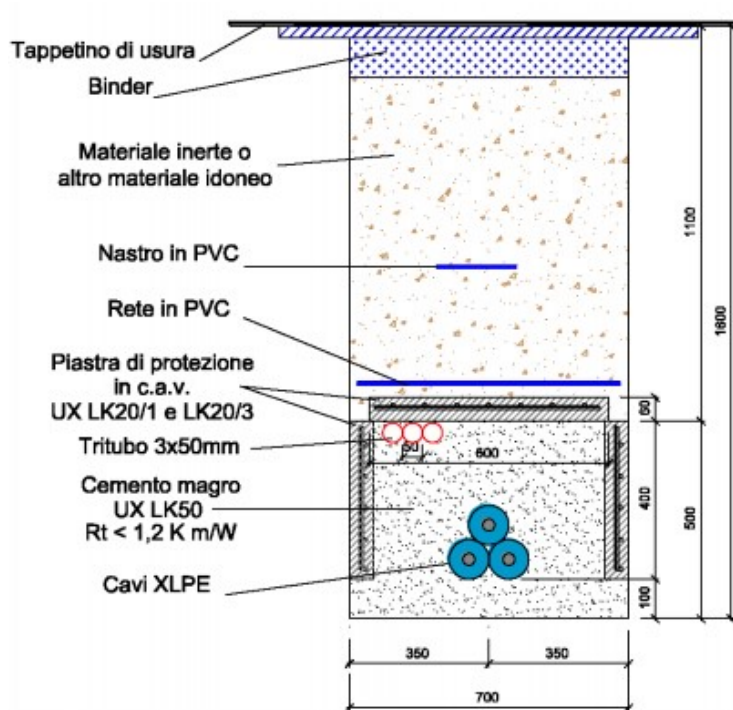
Sezione tipo di cavidotto interrato AT su viabilità stradale
